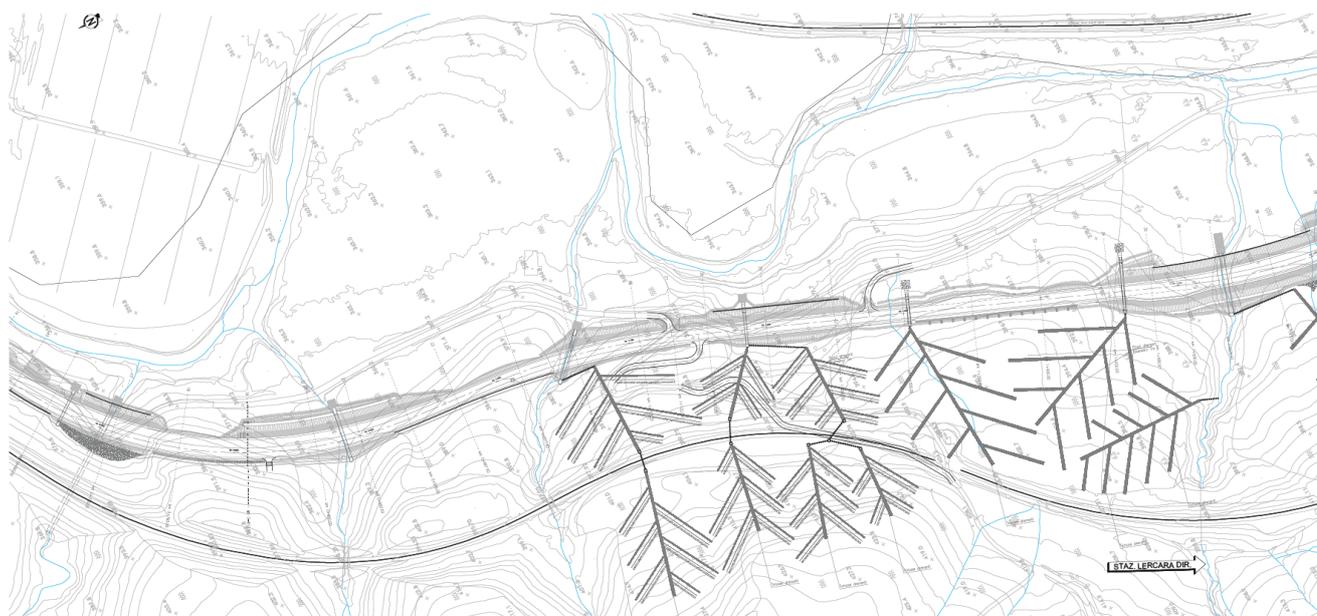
Planimetria di progetto dalla Km 0+750 alla Km 1+535
